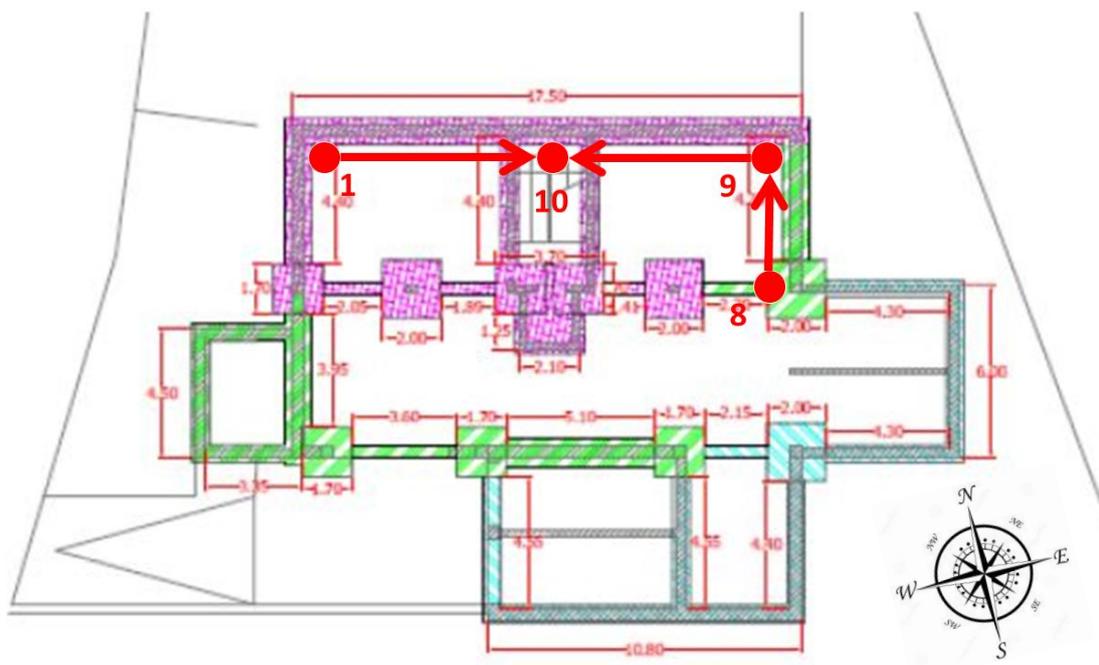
Planimetria con profilo iniezioni 8-9, 9-10 e 1-10
